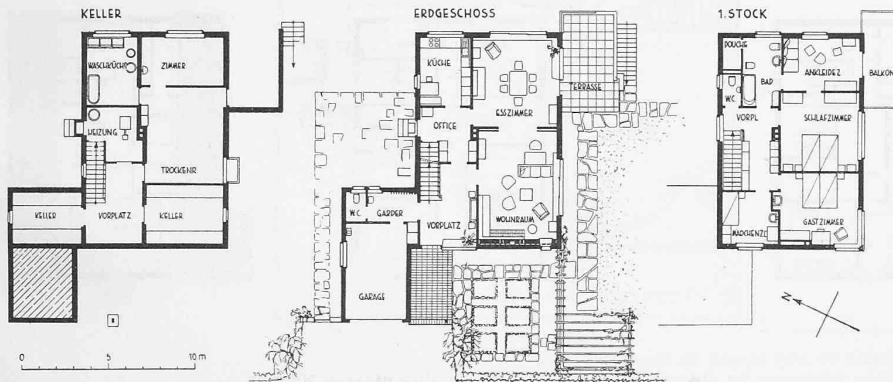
Grundriss des Hauses Kronauer. — Maßstab 1:400.
